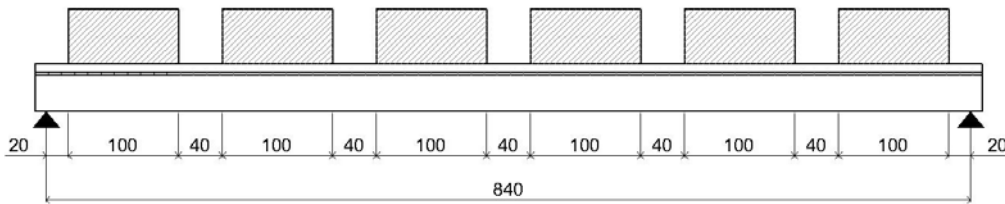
Disposizione dei blocchi di calcestruzzo
